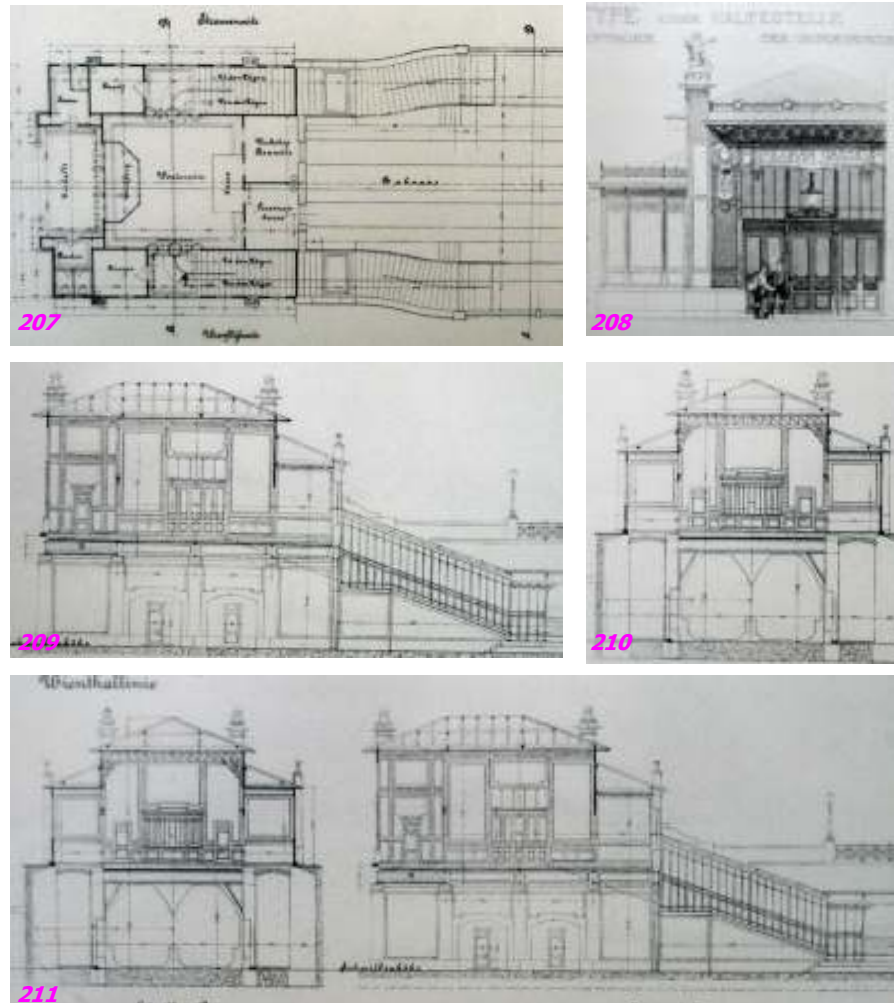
a 2011.- Planos originales de plantas, alzados y secciones.
